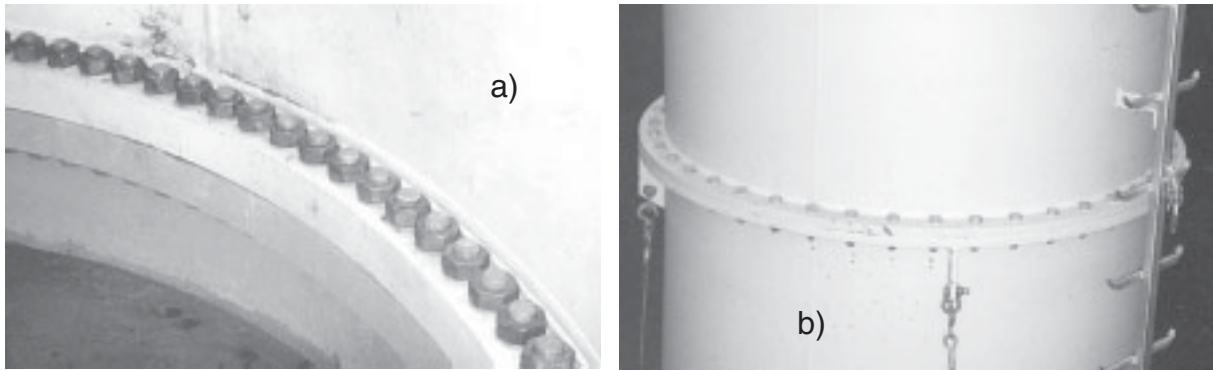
(a) innenliegender L-Ringflanschstoß am WEA-Turmfuß,
